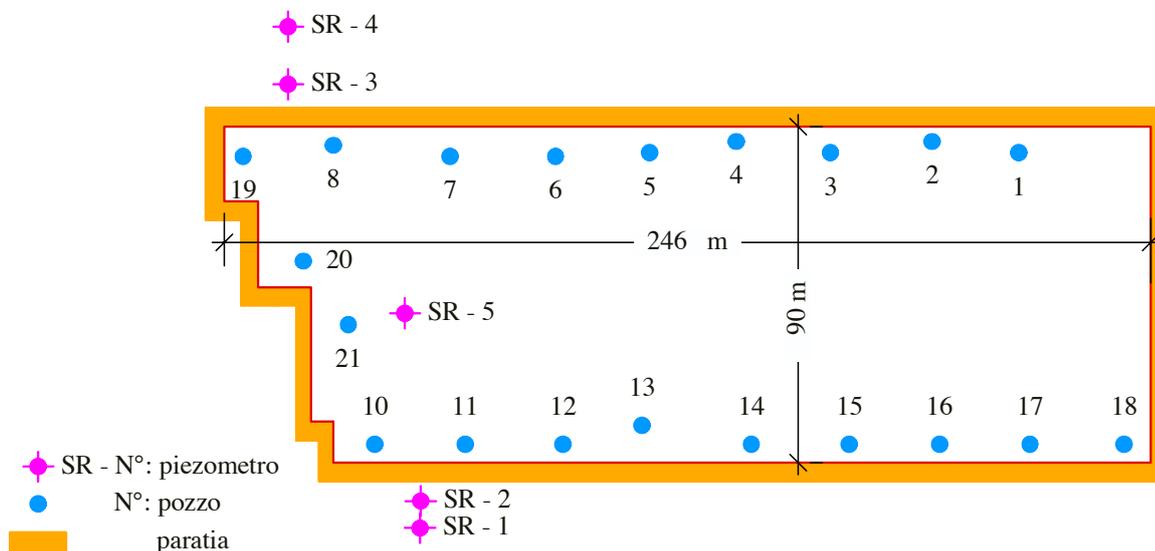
Planimetria della fondazione con indicati pozzi e piezometri.
